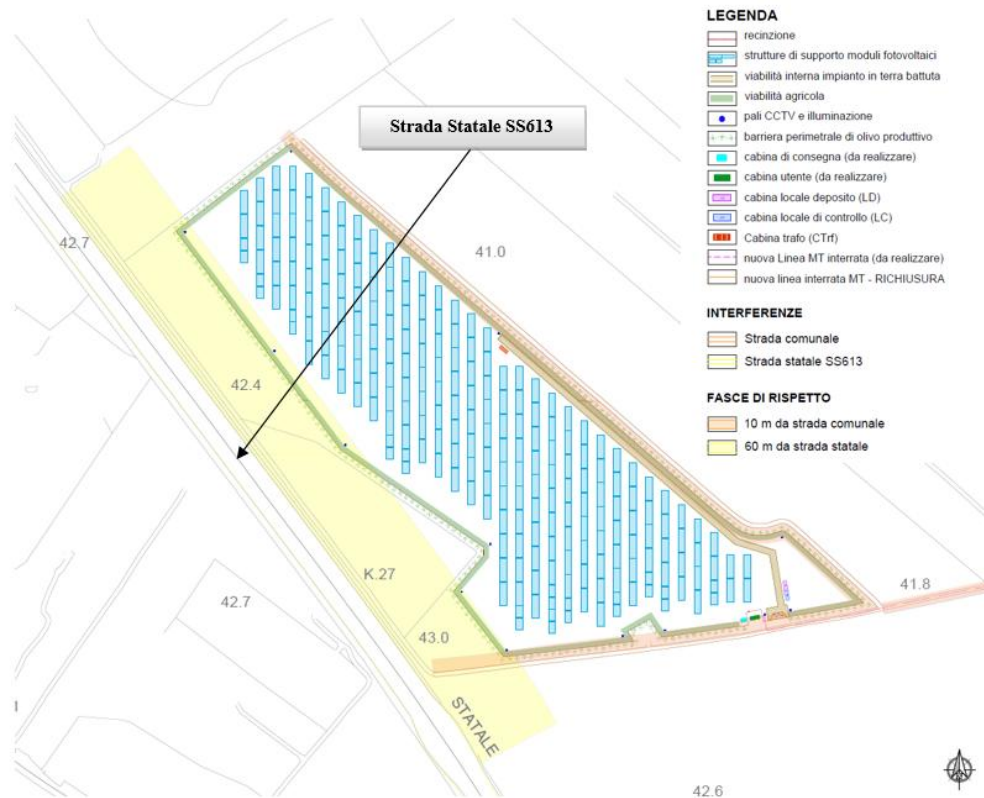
Fascia di rispetto dell'impianto agro-fotovoltaico rispetto alla Strada Statale SS613
